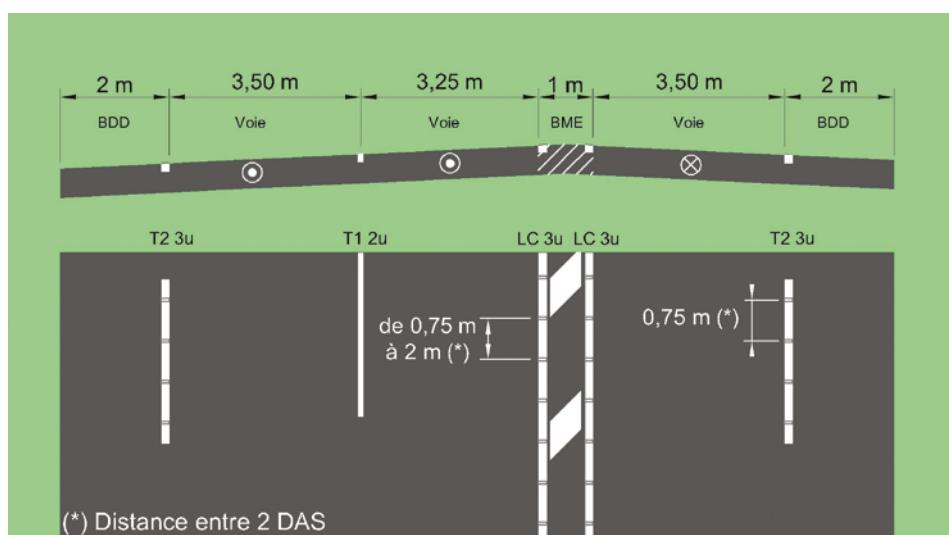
Profil en travers et vue en plan d'une route à 3 voies affectées, avec BME équipée de hachures et d'alerte sonore
